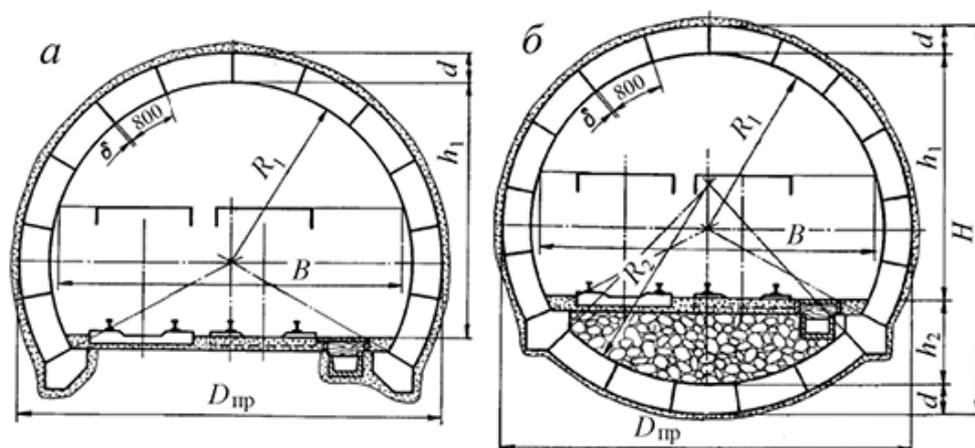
Сплошная блочная бетонная крепь БКА (*а*) и крепь с обратным сводом БКЗ (*б*)
